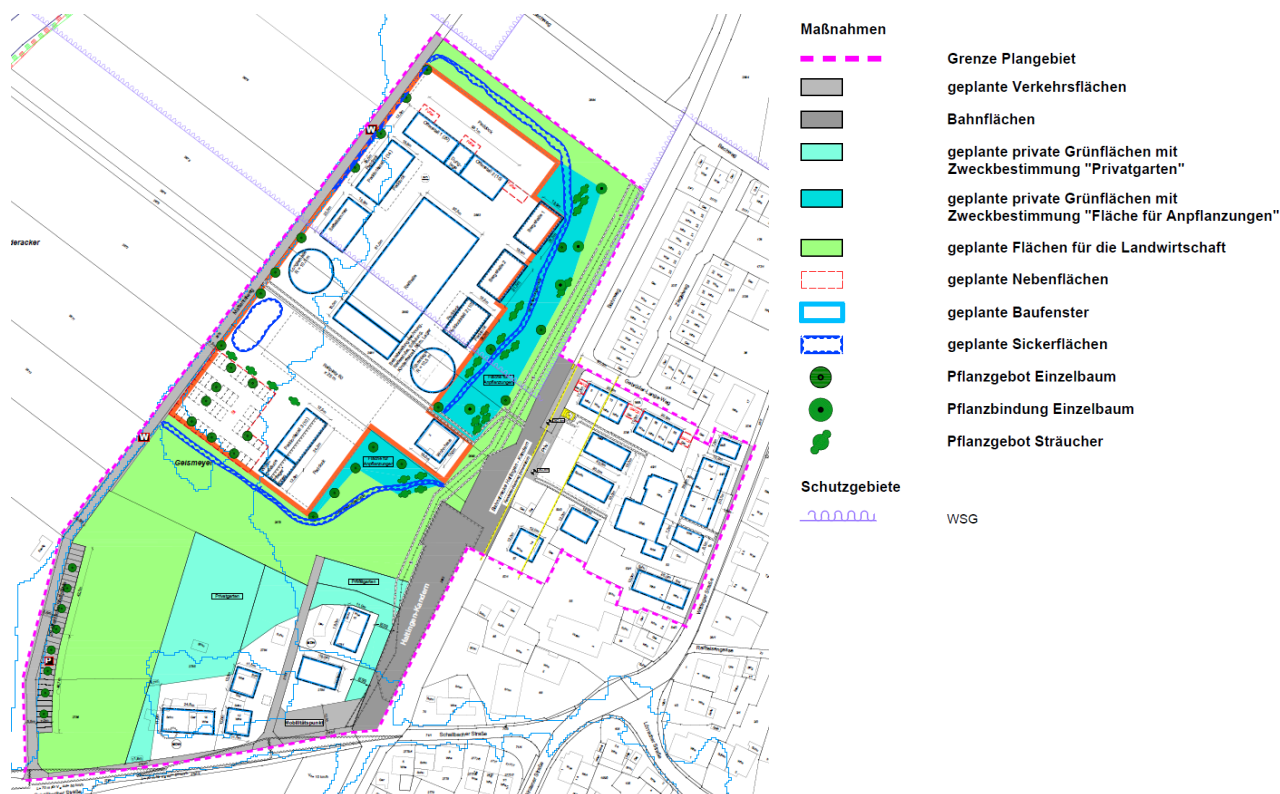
Maßnahmenplan (Quelle: galaplan decker, Stand 22.04.2024)
